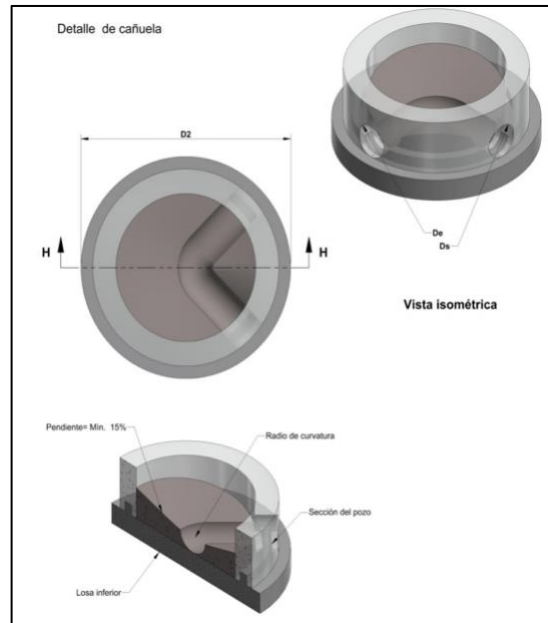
Detalle de cañuela. Fuente. EPM, 2017
